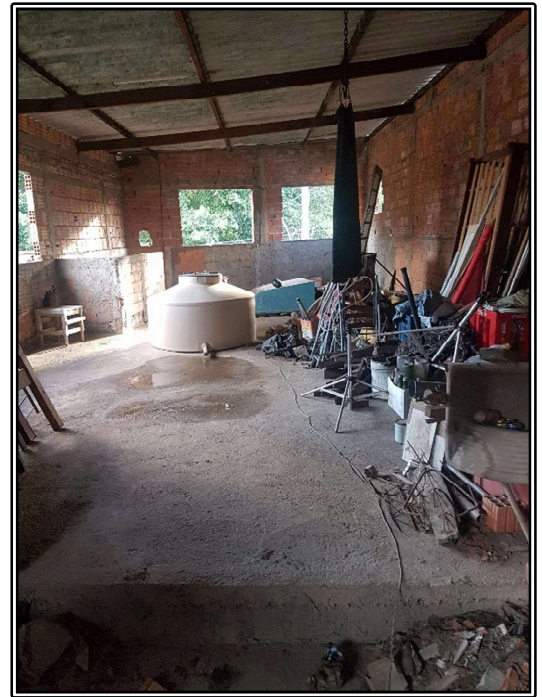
e 30 Vista do acesso ao terceiro pavimento
